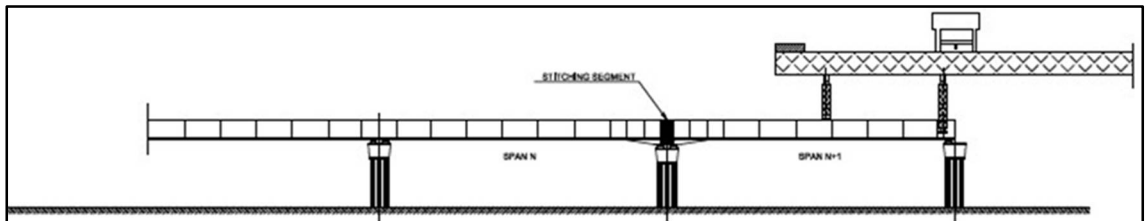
Avance de la viga lanzadora y colado del diafragma sobre pila central
